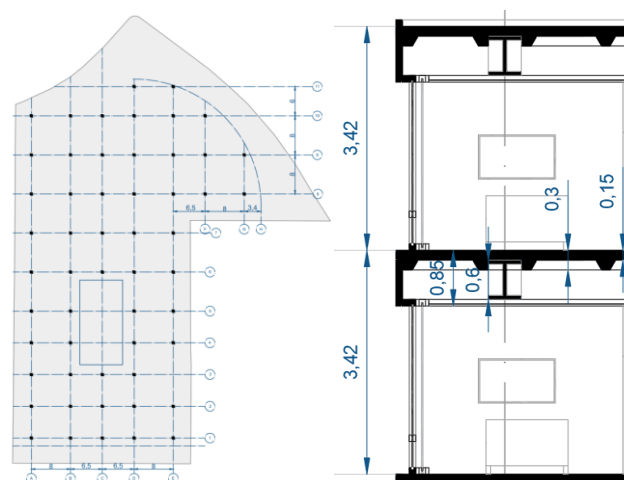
Diagrama de estructura en planta. Elaboración propia.
